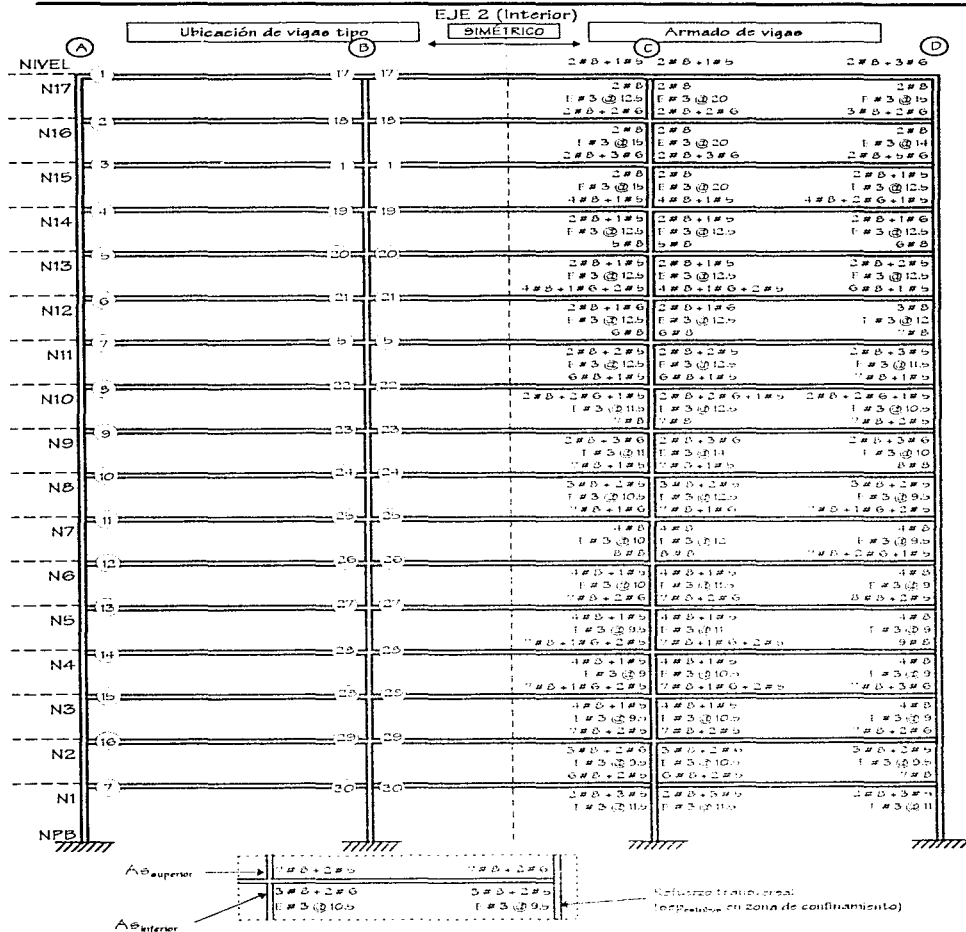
Ubicación de los tipos de armados de las vigas del eje 2 de la estructura de 17 niveles diseñada en la zona II
